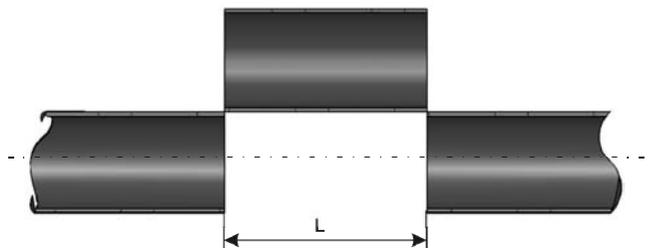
Схема врезки в трубопровод для установки расходомера
